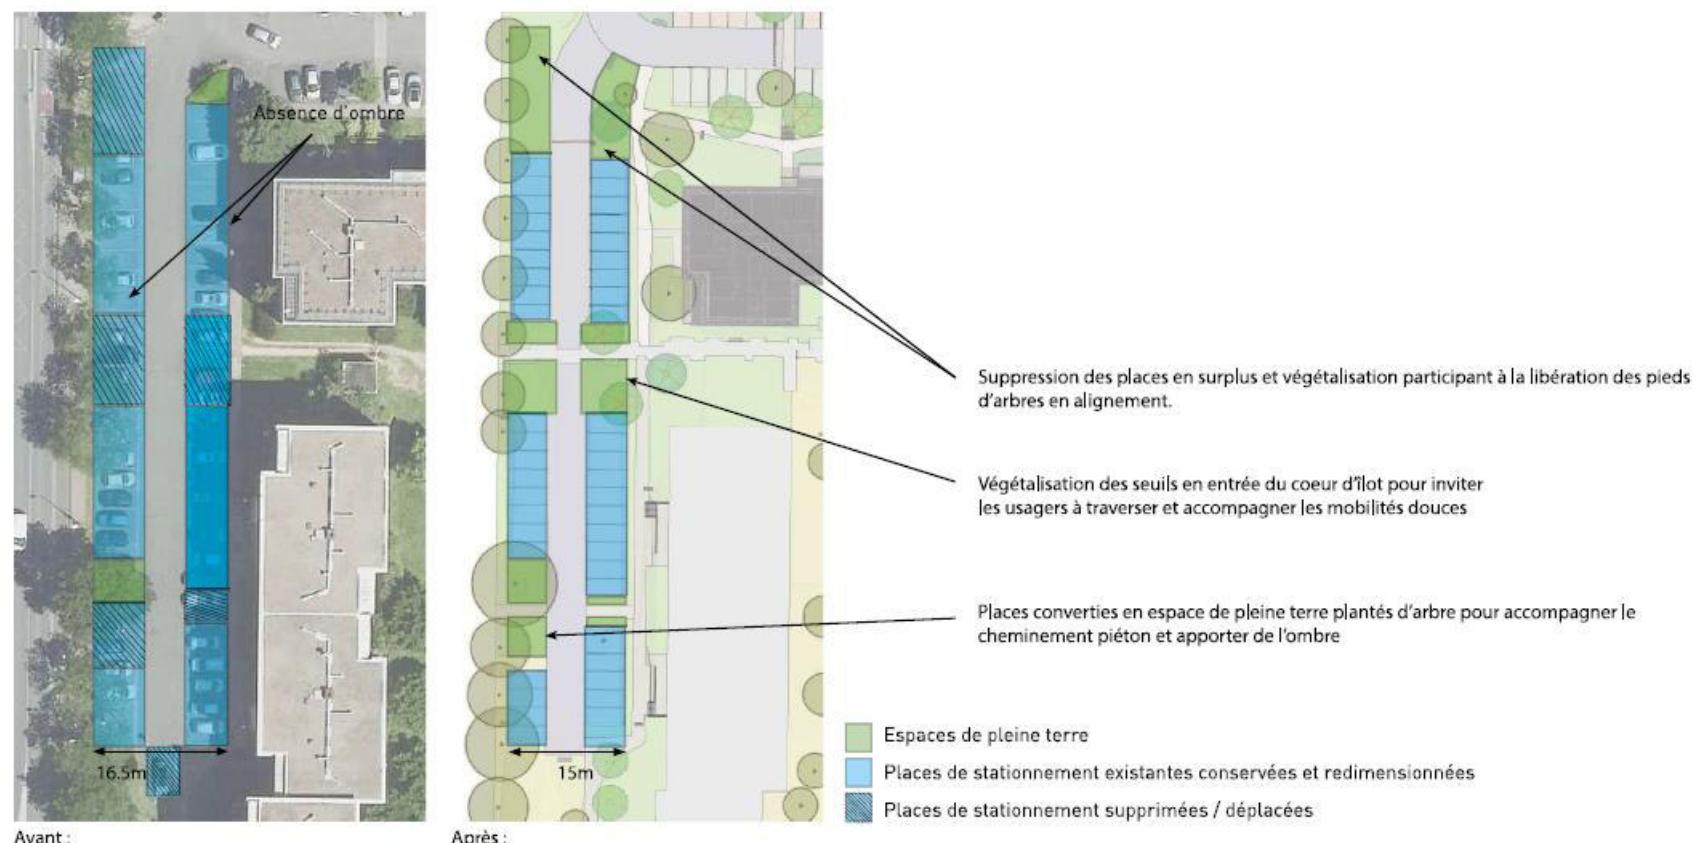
Modification des places de stationnement au droit du parking Celuta – îlot Nord (Source : Land'Act, 2025)
